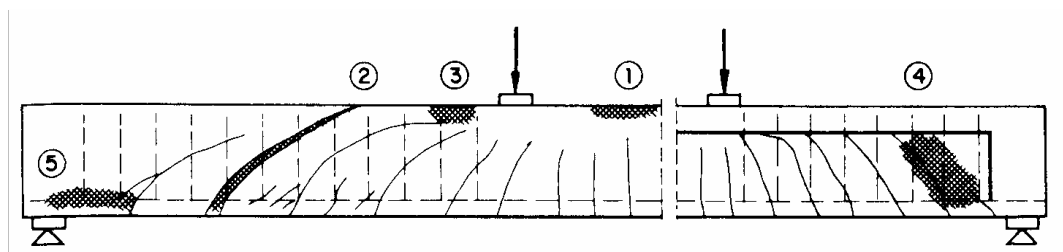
Formas de rotura de una viga esbelta (Rüsch, 1972)
